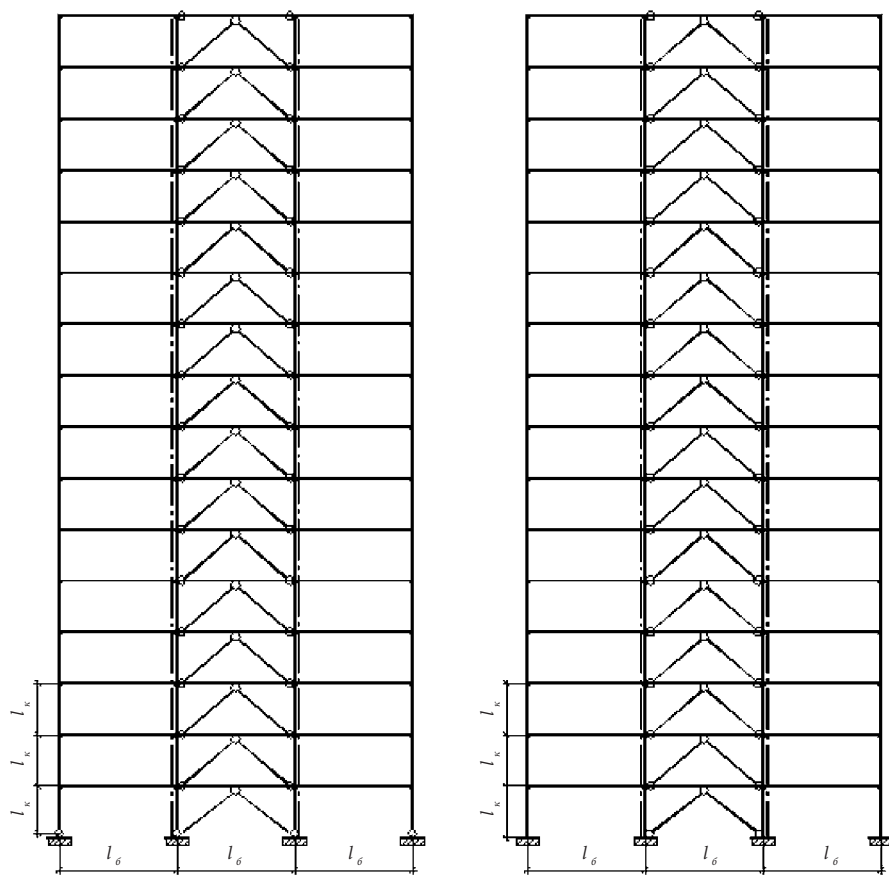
Рамно-связевые каркасы: а) шарнирное крепление колонн к фундаменту; б) жесткое крепление колонн к фундаменту
